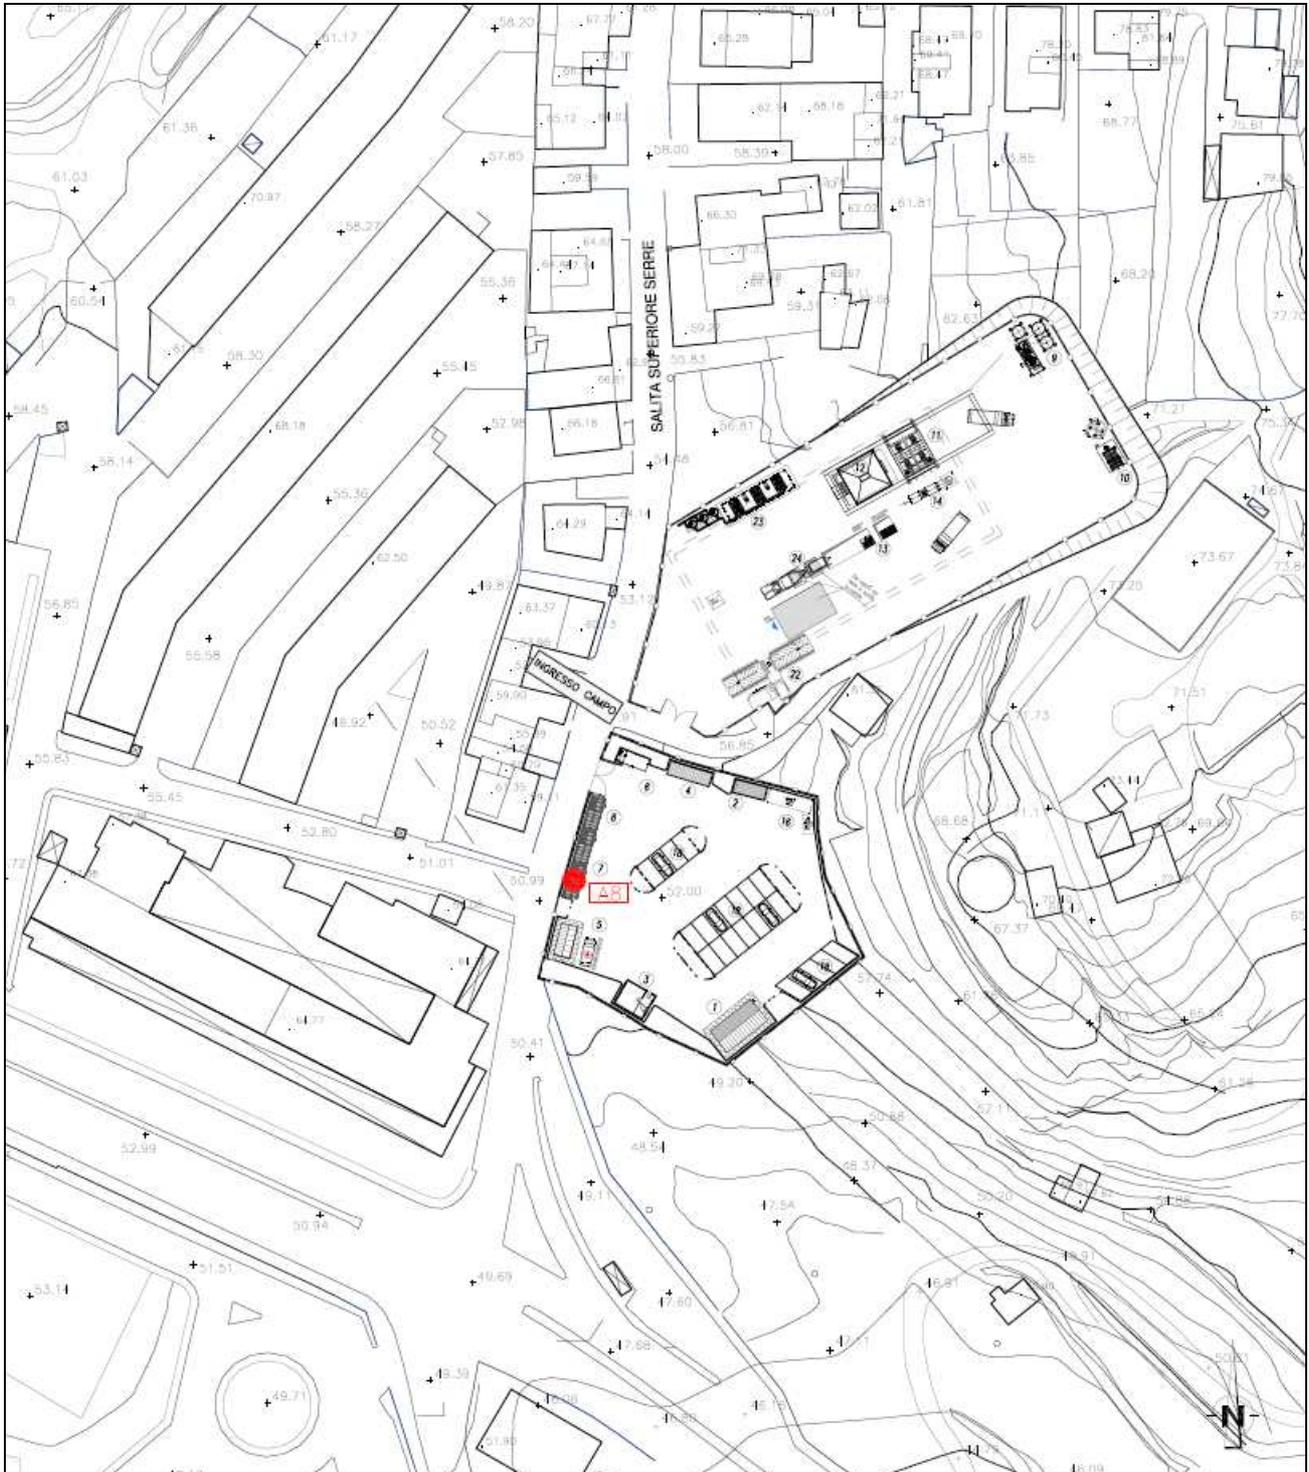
Cantiere SS1 Stazione Papardo – Localizzazione punti allacciamento
